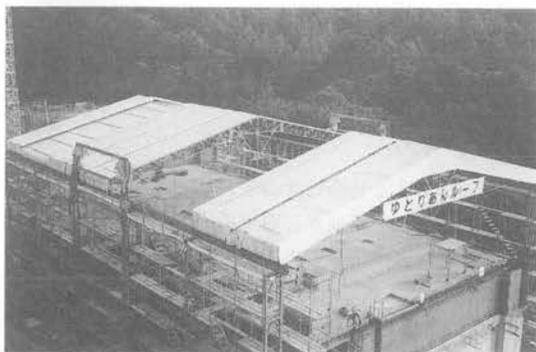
ゆとりあんルーフ通常施工時（屋根一部開）
